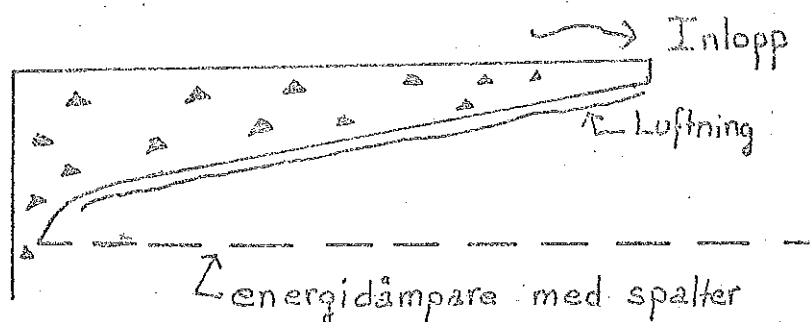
Plan av inlopp till sedimenteringsbassäng
